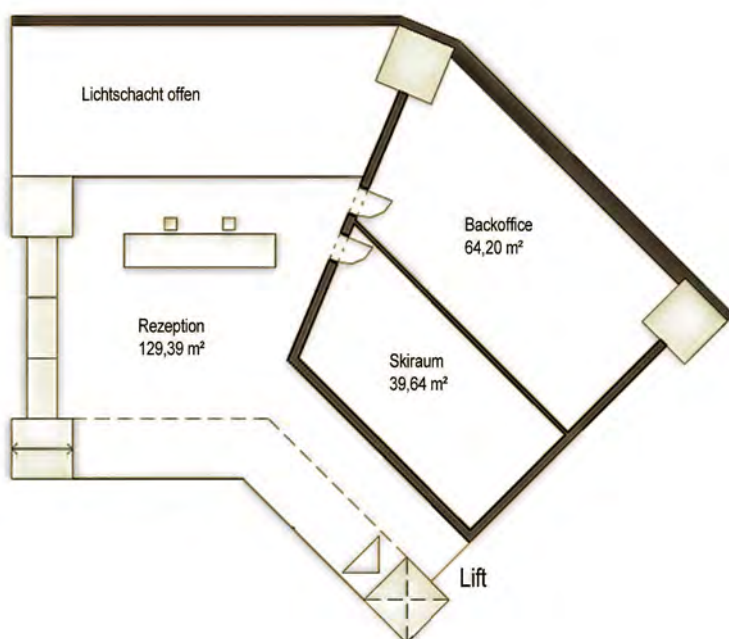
Plan Ausschnitt Rezeption und Nebenräume
